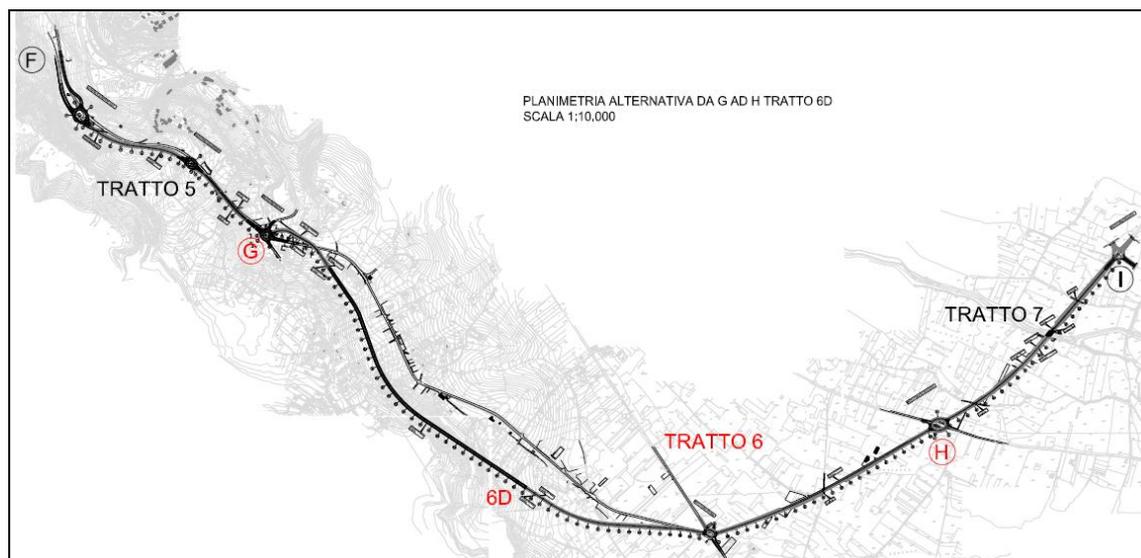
Planimetria LOTTO B con Alternativa di progetto 6D
